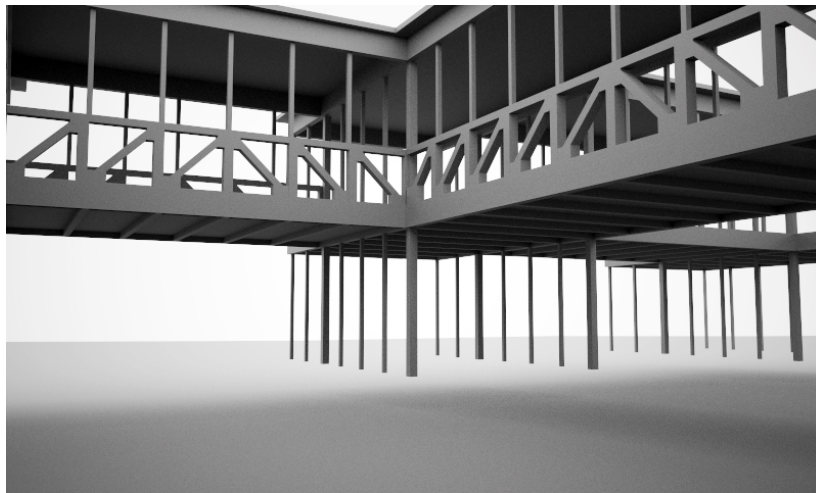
Projeto tridimensional da estrutura projetada por Baumgart. A imagem demonstra a treliça em concreto armado que possibilitou o vão em balanço livre, os pilares de sustentação que permitiram a realização da janela em fita em forma de basculantes. Fonte: Autor, 2014.
